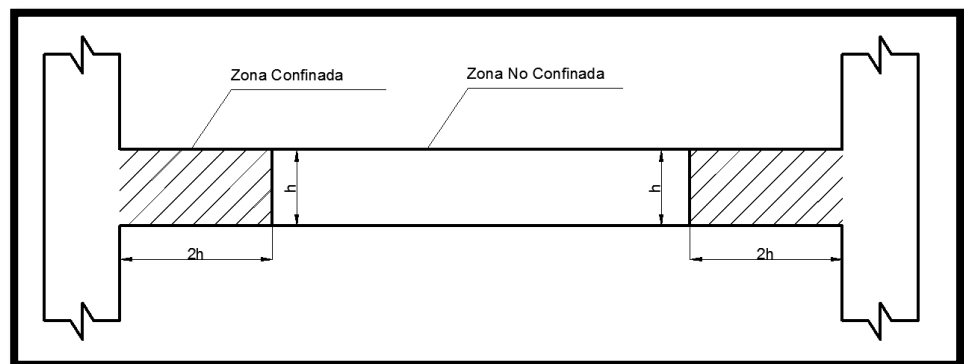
Longitud de Zona de Confinamiento en Vigas
